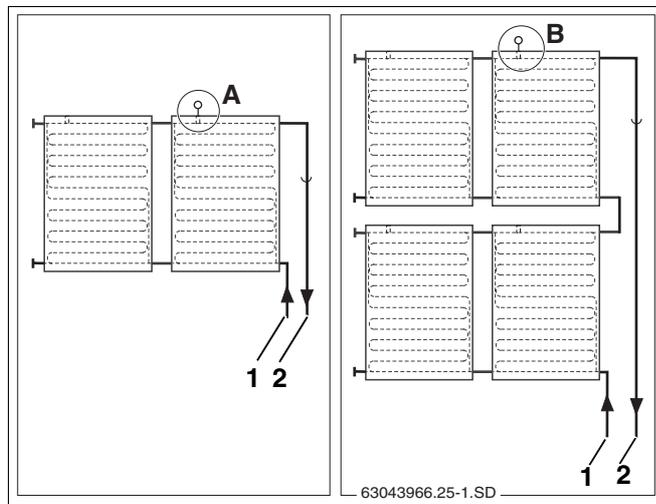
Posto d'installazione della sonda del collettore (rappresentazione schematica)
